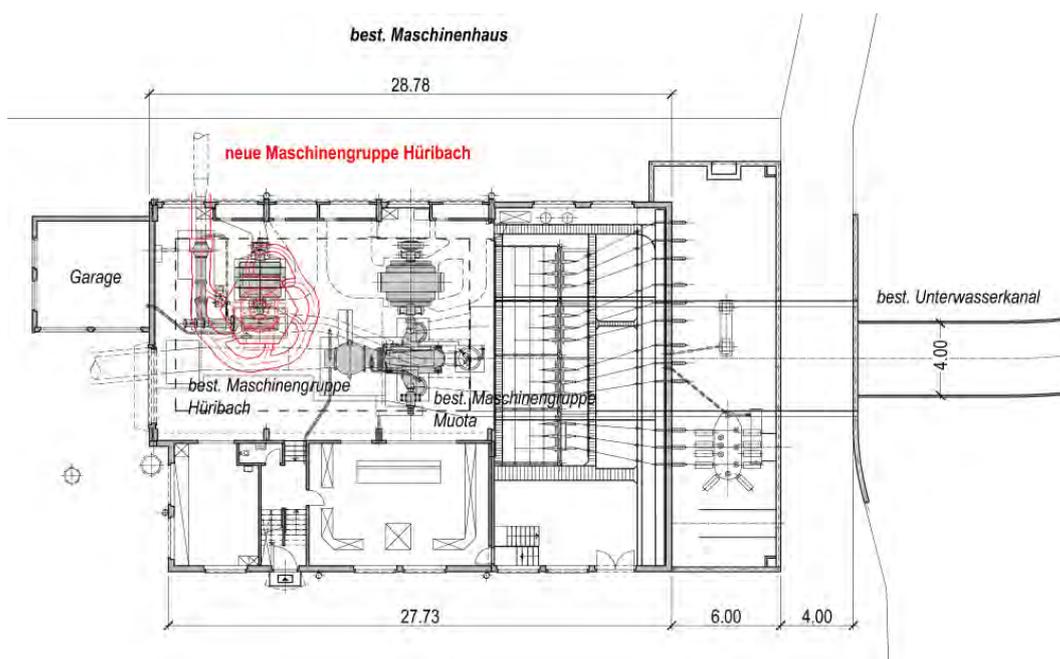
Grundriss des Maschinenhauses Hinterthal.
